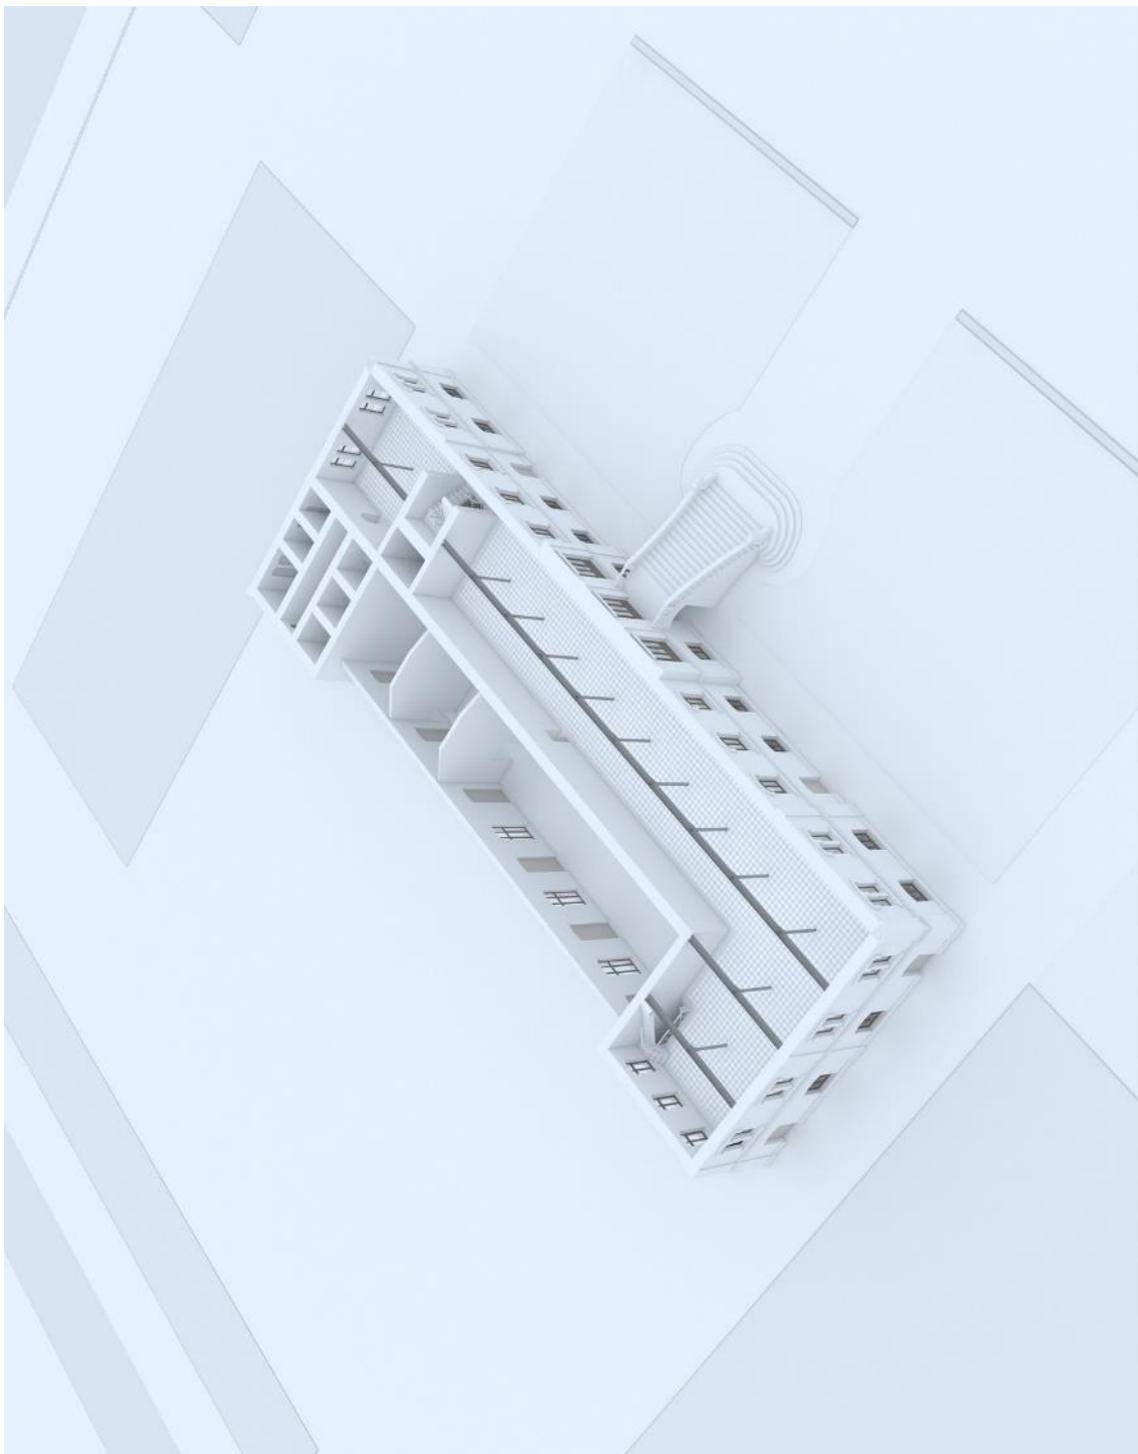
Imagen virtual. La fábrica. Planta primera. Sección por debajo de las viguetas de forjado.
